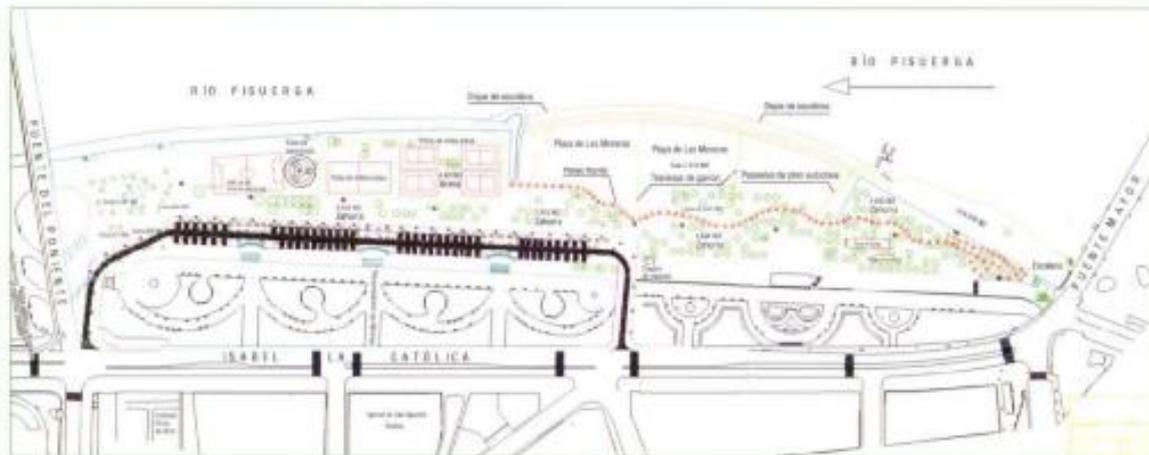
Planta general del "Proyecto de protección y ordenación de la playa de 'Las Morenas' y su entorno".
